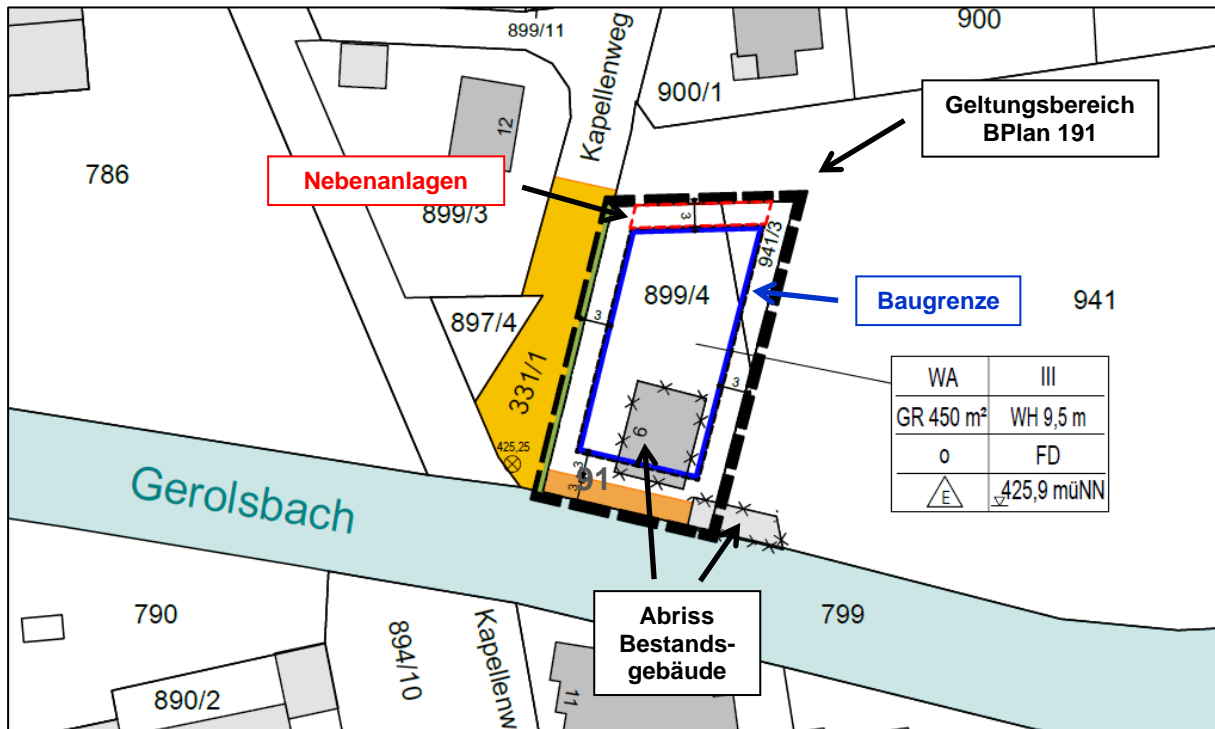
Lageplan BPlan 191 (Ausschnitt);
